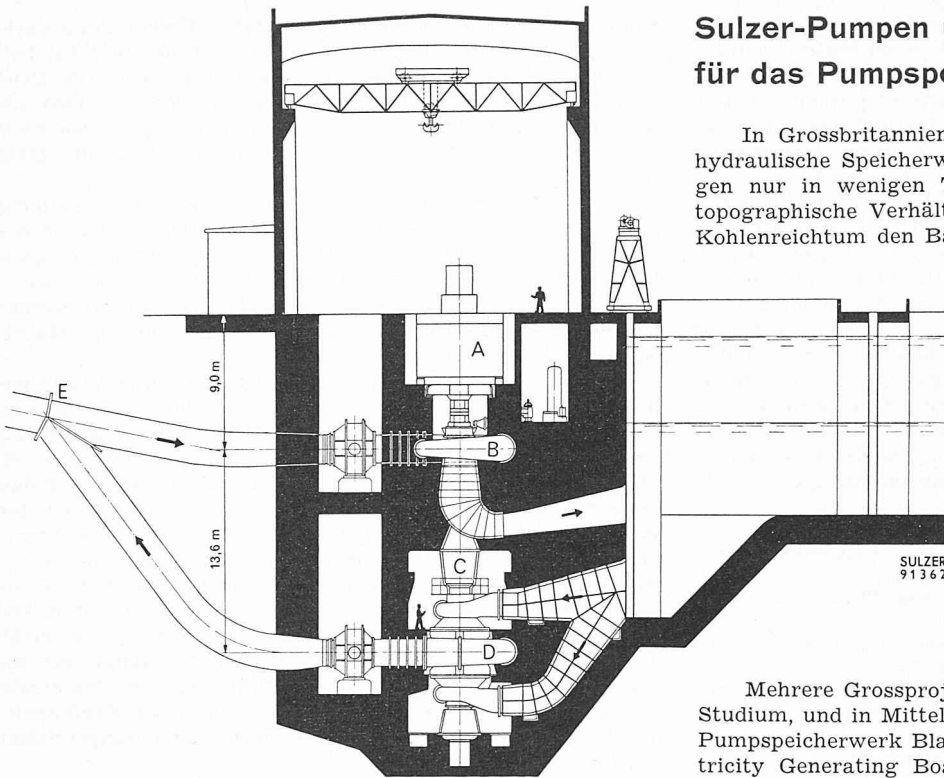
Querschnitt durch das Maschinenhaus, 1:500
